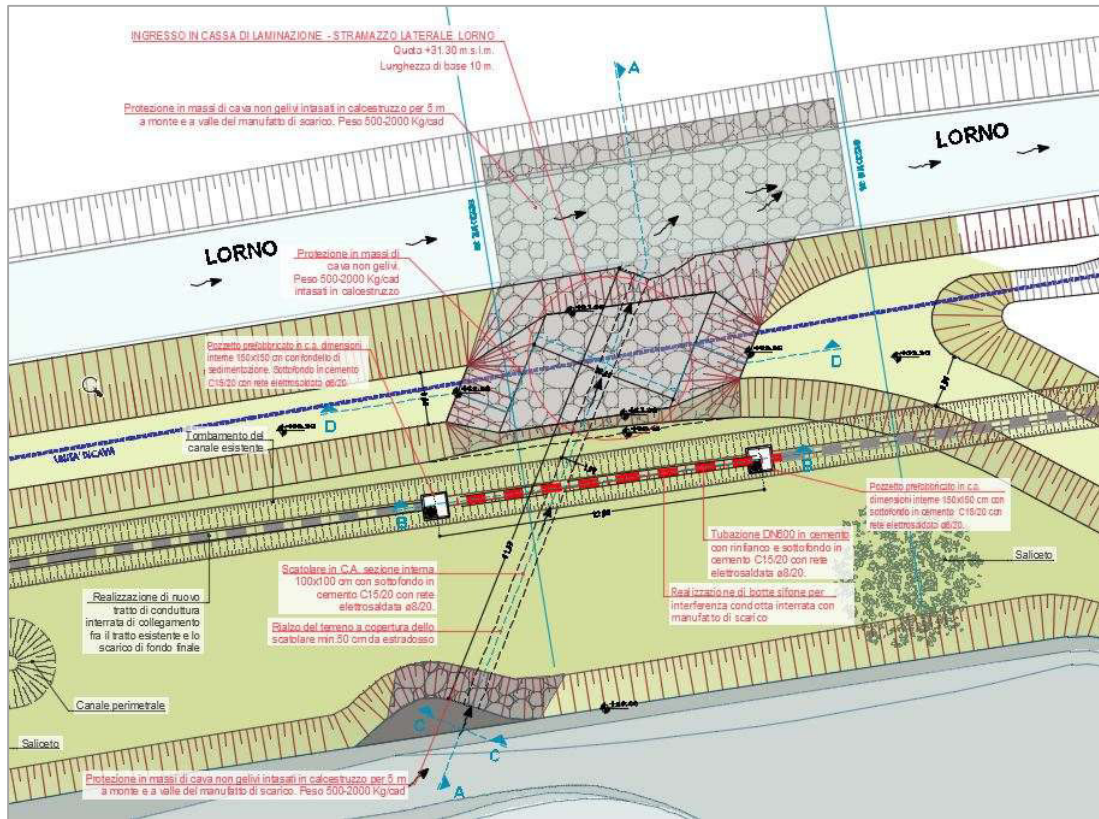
Manufatto di scarico canale Lorno: planimetria.
